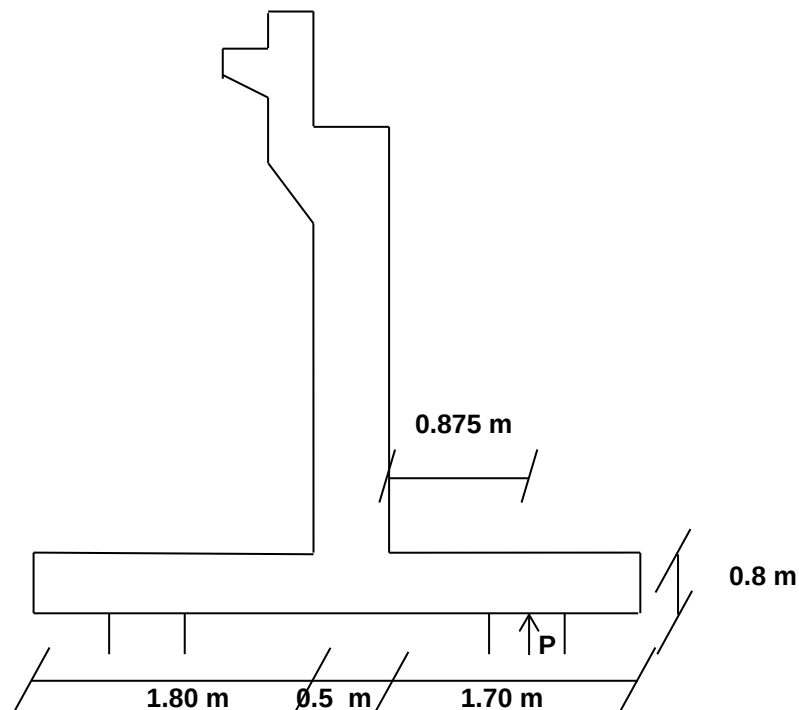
Acción de la fuerza del pilote sobre la punta de la zapata.
